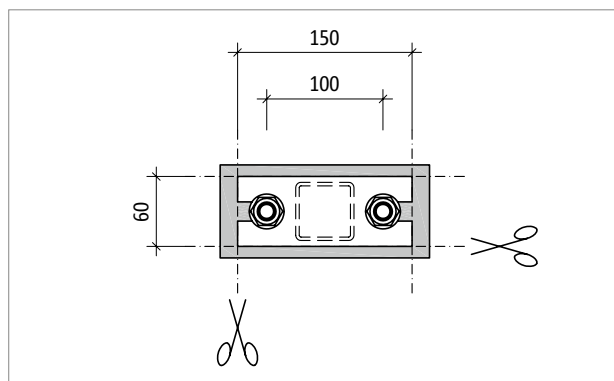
Schöck Isokorb® T type S-V : dimensions après découpe du corps isolant
